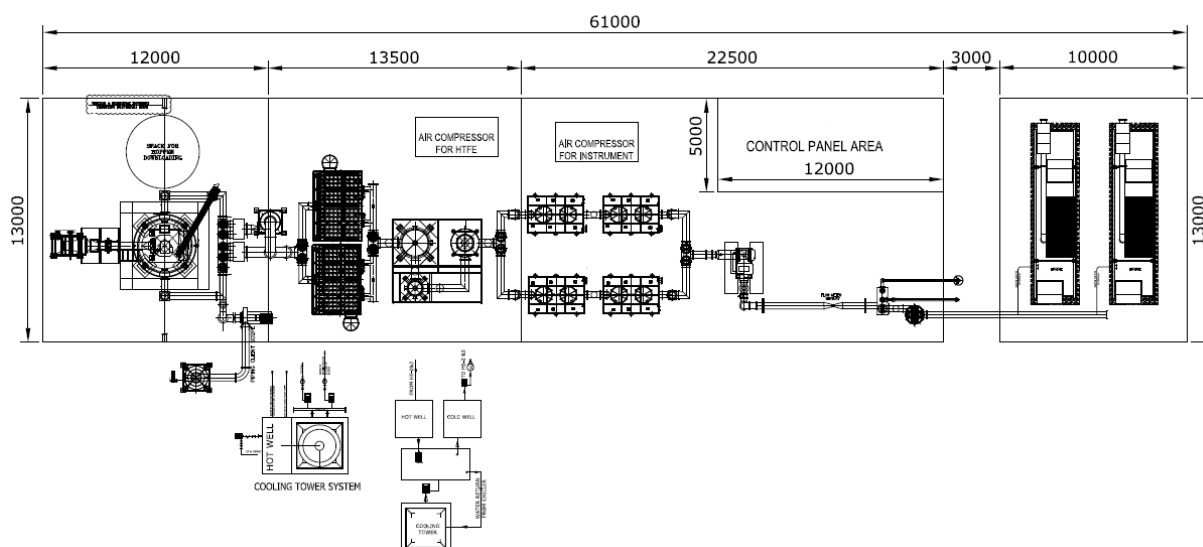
Distribución en planta del sistema de gasificación. Fuente ANKUR
